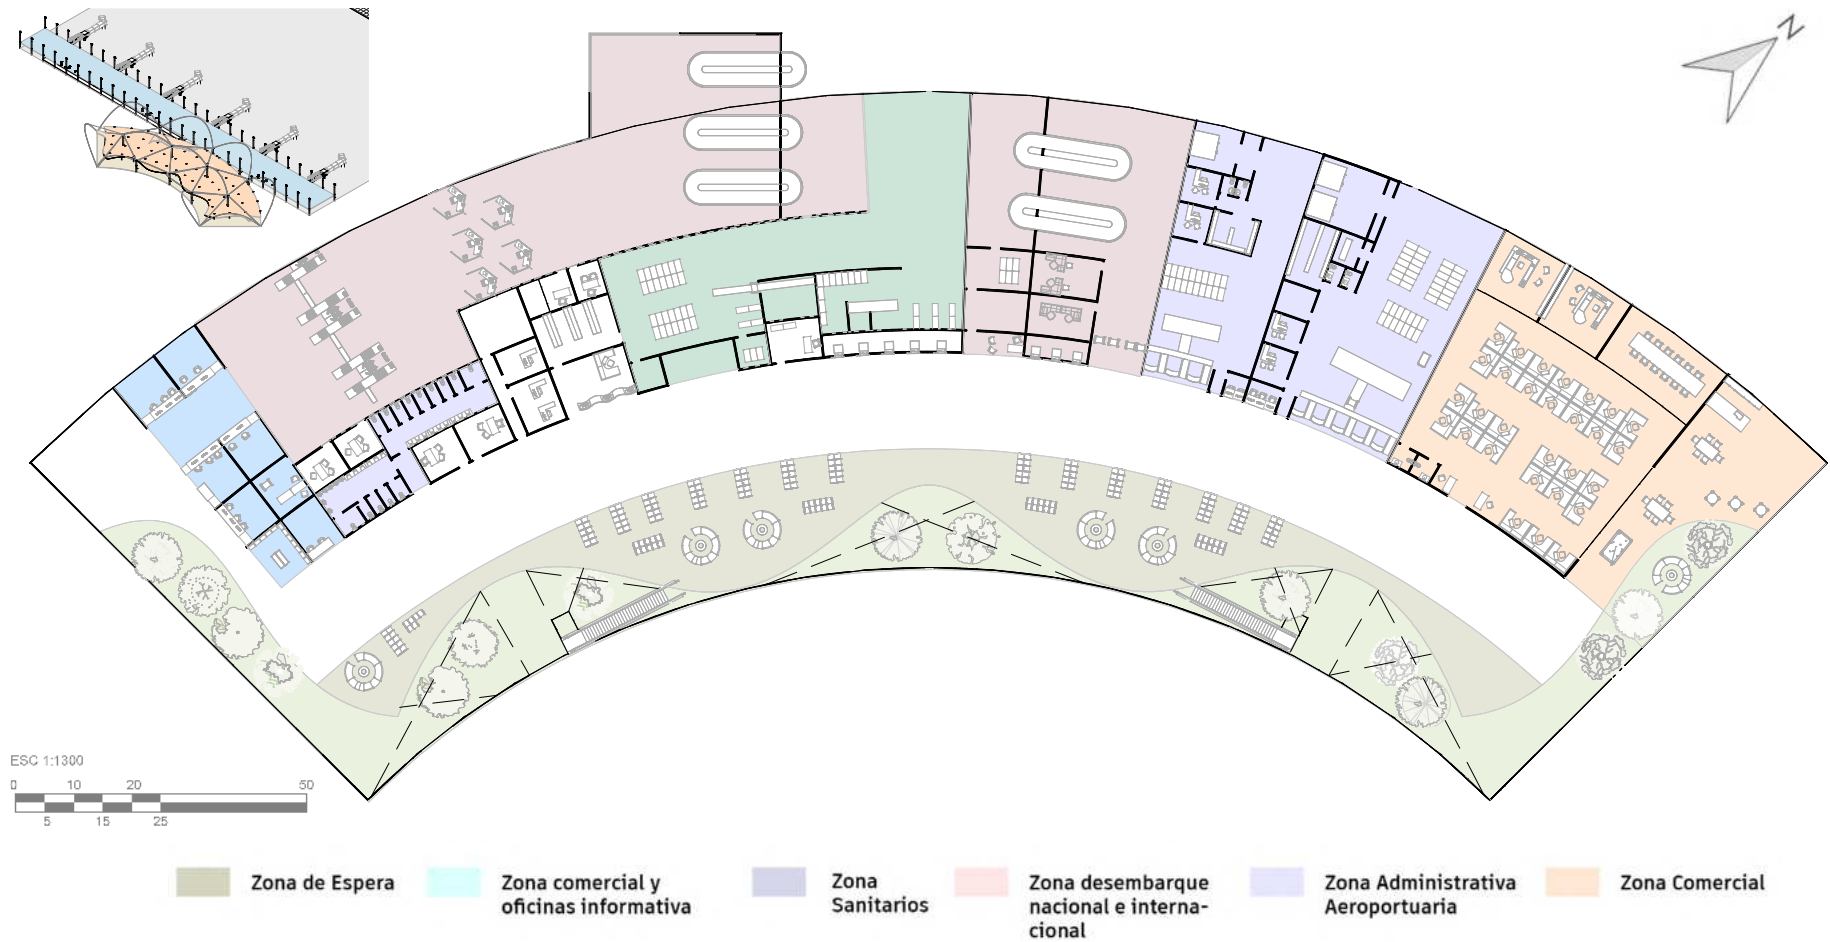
Relación de niveles, Planta baja y Planta alta
